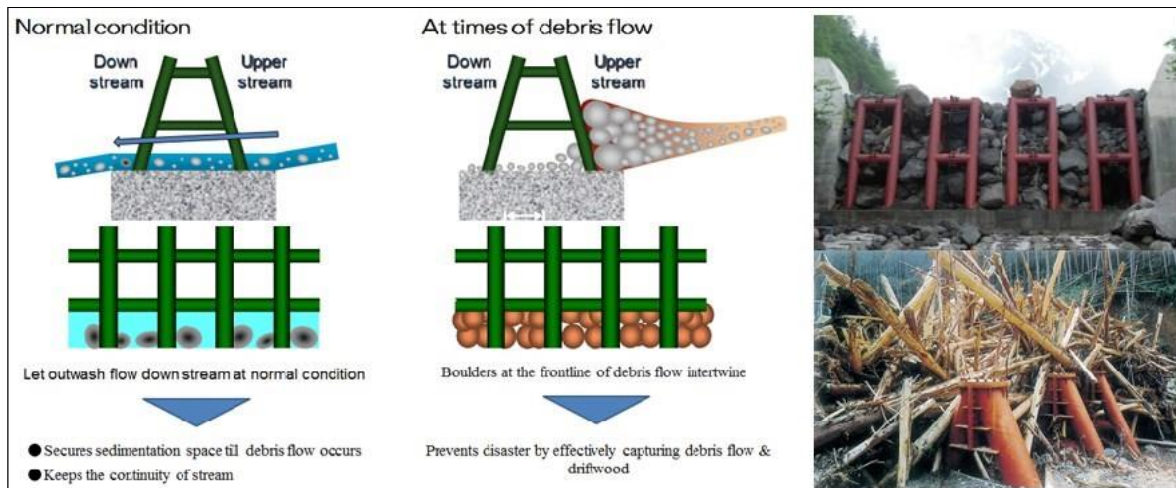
Steel slit dam. Fuente: <https://www.bosai-jp.org/en/solution/detail/26/search>
